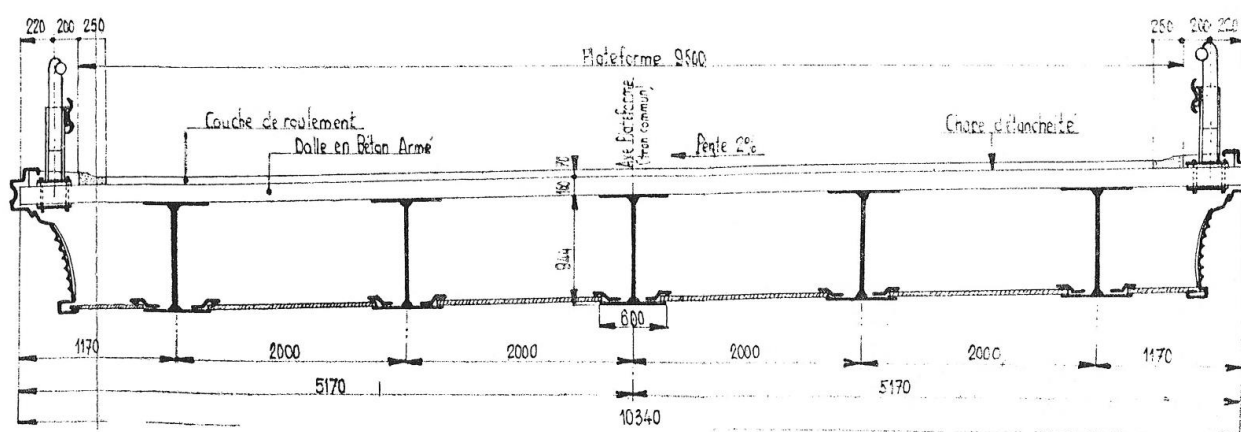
Extrait DOE – Coupe transversale de l'ouvrage
